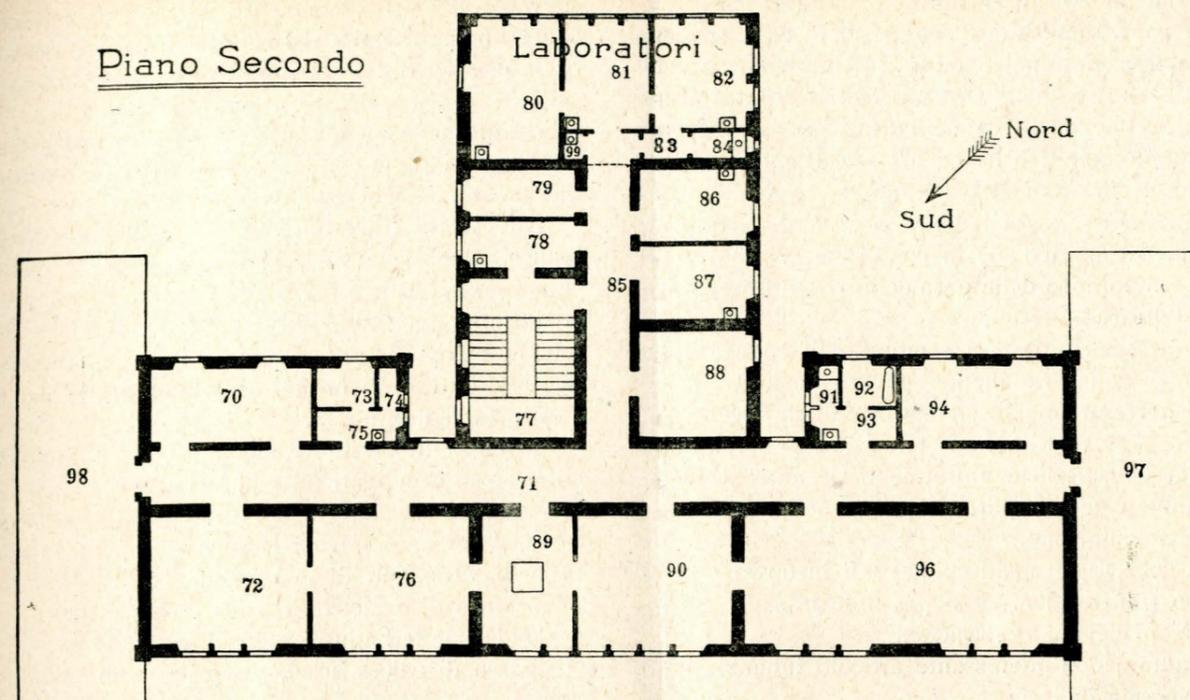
Pianta del secondo Piano: 70. Stanza per bambini divezzati - 71. Corridoio principale - 72. Stanza per lattanti - 73. Stanza incubatrice - 74. Scala in ferro - 75. Lavabo - 76. Stanza per lattanti - 77. Scala - 78. Stanza di accettazione degli esposti - 79. Stanza di osservazione - 80. Gabinetto di bacteriologia - 81. Gabinetto per ricerche chimiche - 82. Gabinetto per microscopia - 83 e 84. Latrina ed antilatrina - 85. Corridoio - 86.
